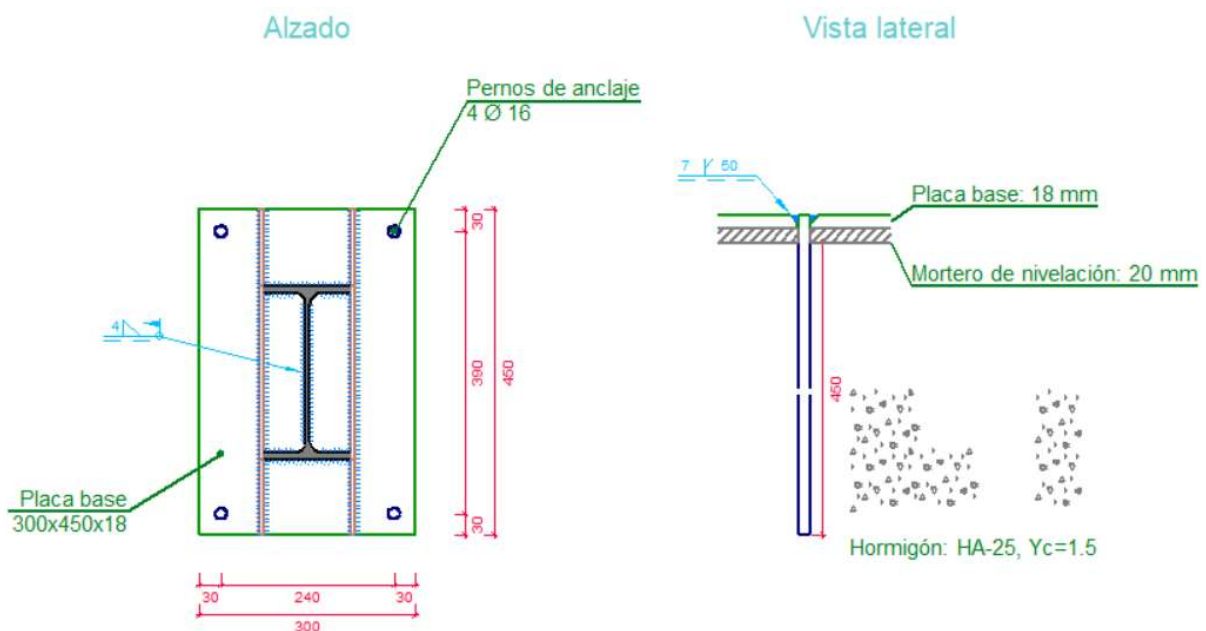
detalles de pernos de anclaje junto a la placa de anclaje
